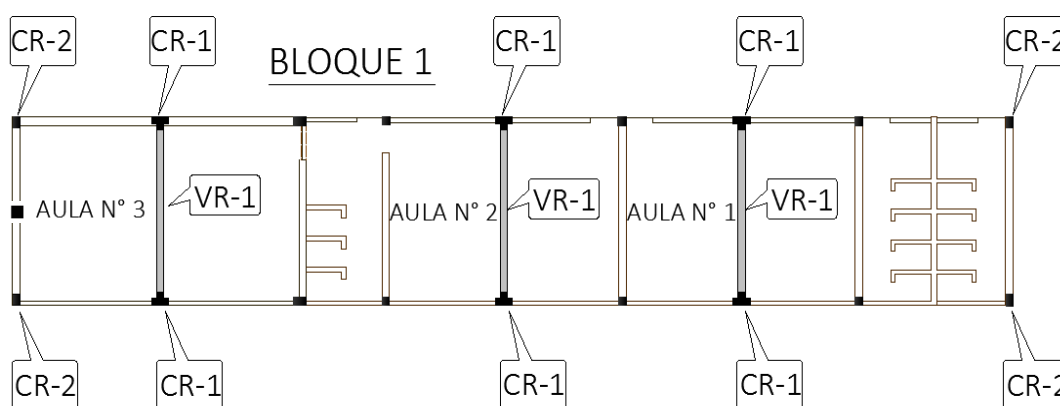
Ubicación de las columnas propuestas para reforzamiento
